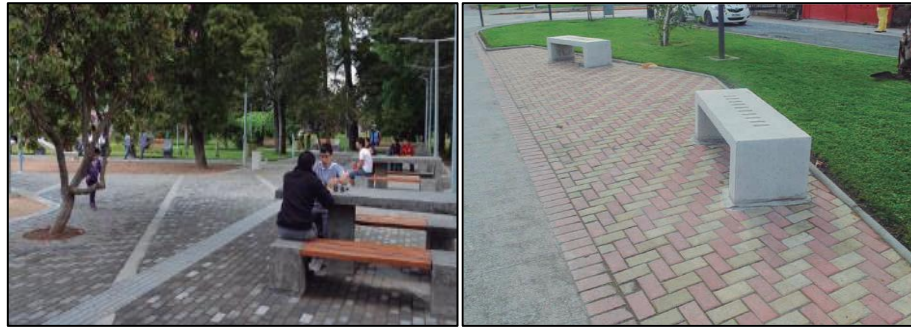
Ejemplos de pavimentos de adoquines de hormigón
